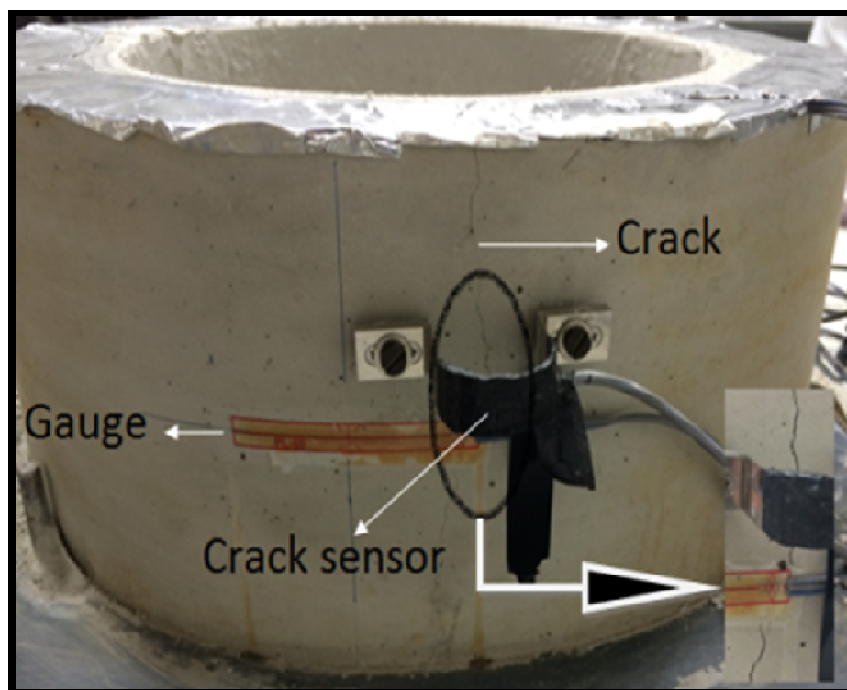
Les installations des jauges de déformation et le capteur de fissure sur les anneaux en béton.
